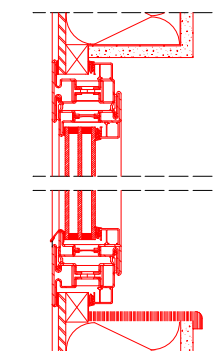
Detailschnitt Stahl-Glas-Vorhangfassade, ohne Maßstab
